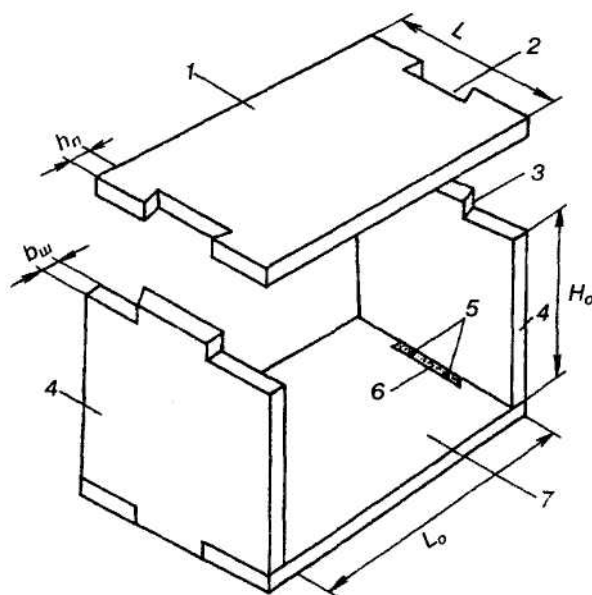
Звено прямоугольной железобетонной трубы из плитных элементов:
